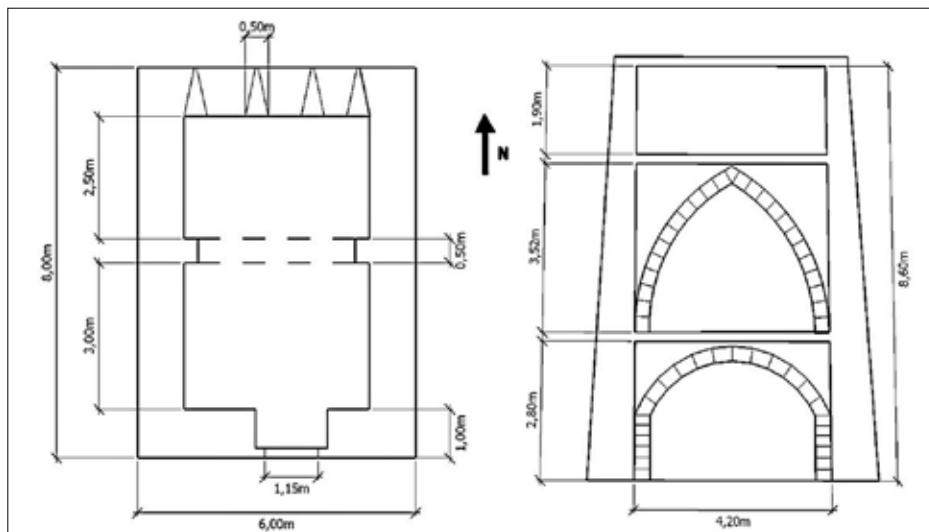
Planta i possible secció de la torre dels Galls Carnuts.
